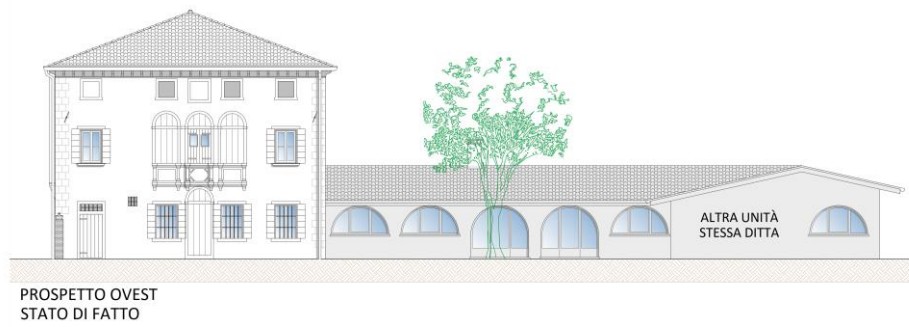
Prospetto Ovest - Stato di fatto – scala generica
